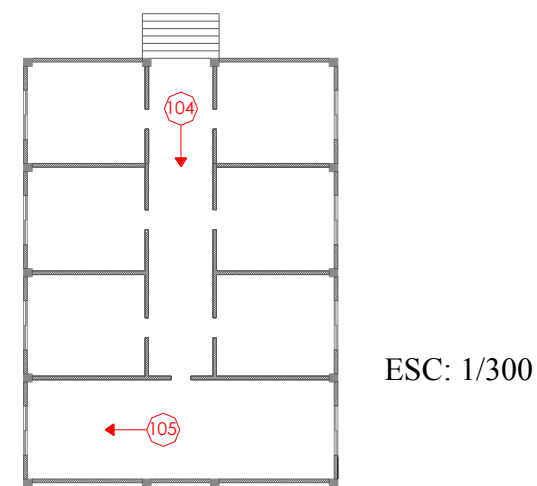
Planta Subterránea 2: Ubicación vista de fotografía
